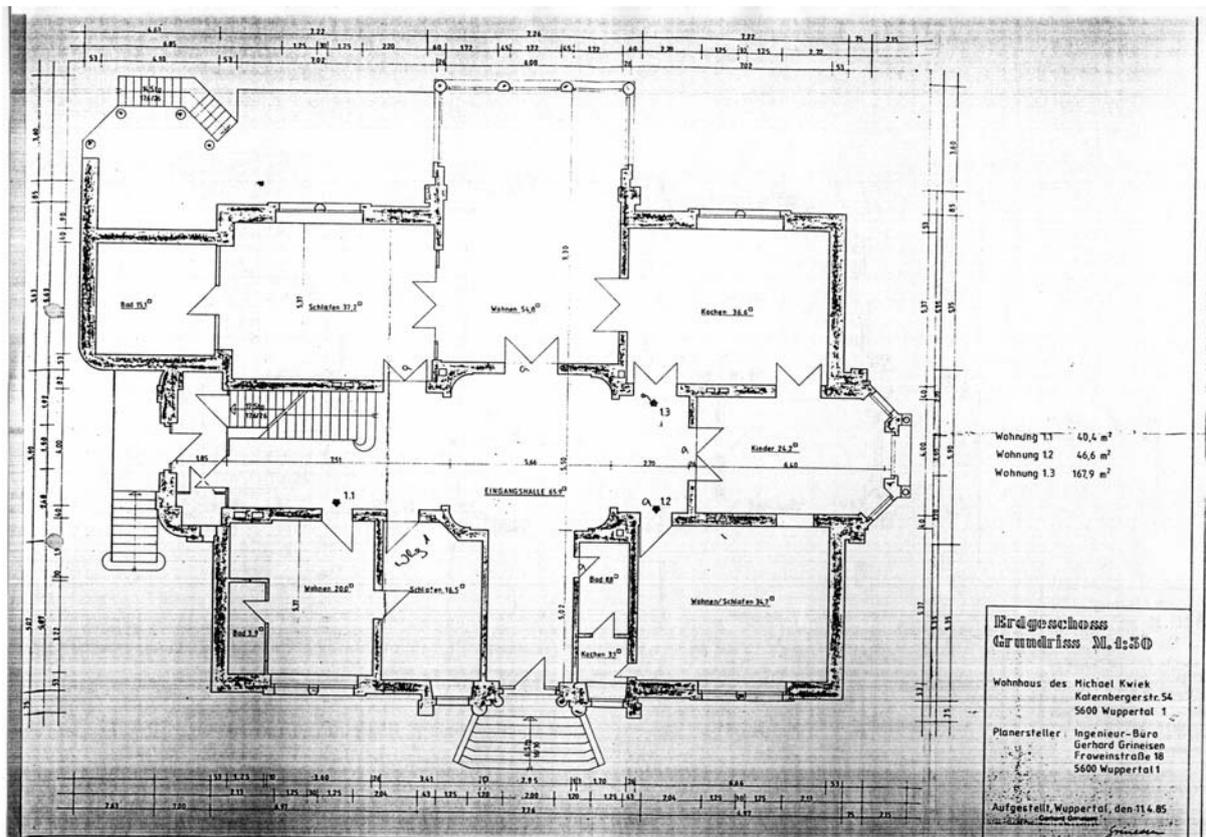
Villa Otto Baum, Grundriss Erdgeschoss mit den Anbauten der Terrasse und des zweiten Wintergartens, angefertigt vom Ingenieur-Büro Grineisen, Wuppertal, 1985
